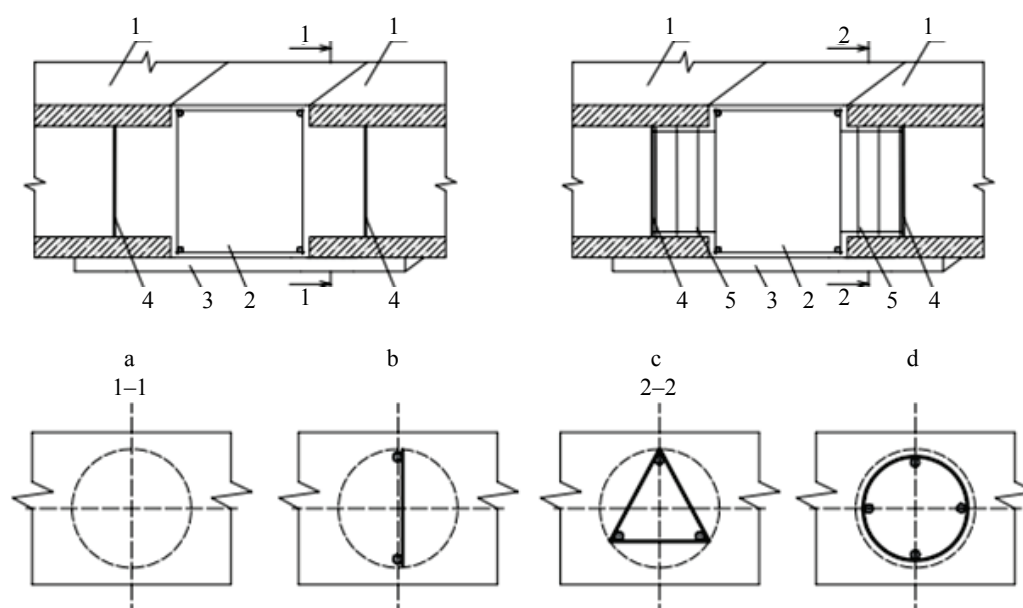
Узел опирания многопустотных плит на монолитный ригель сборно-монолитного перекрытия через бетонные шпонки (а), армированные плоскими (б) и пространственными в виде полый призмы с треугольником в основе (с) или полого цилиндра (д) каркасами шпонок: 1 – многопустотная плита; 2 – ригель; 3 – опалубка; 4 – арматурный каркас шпонки; 5 – заглушка для ограничения глубины шпонки
